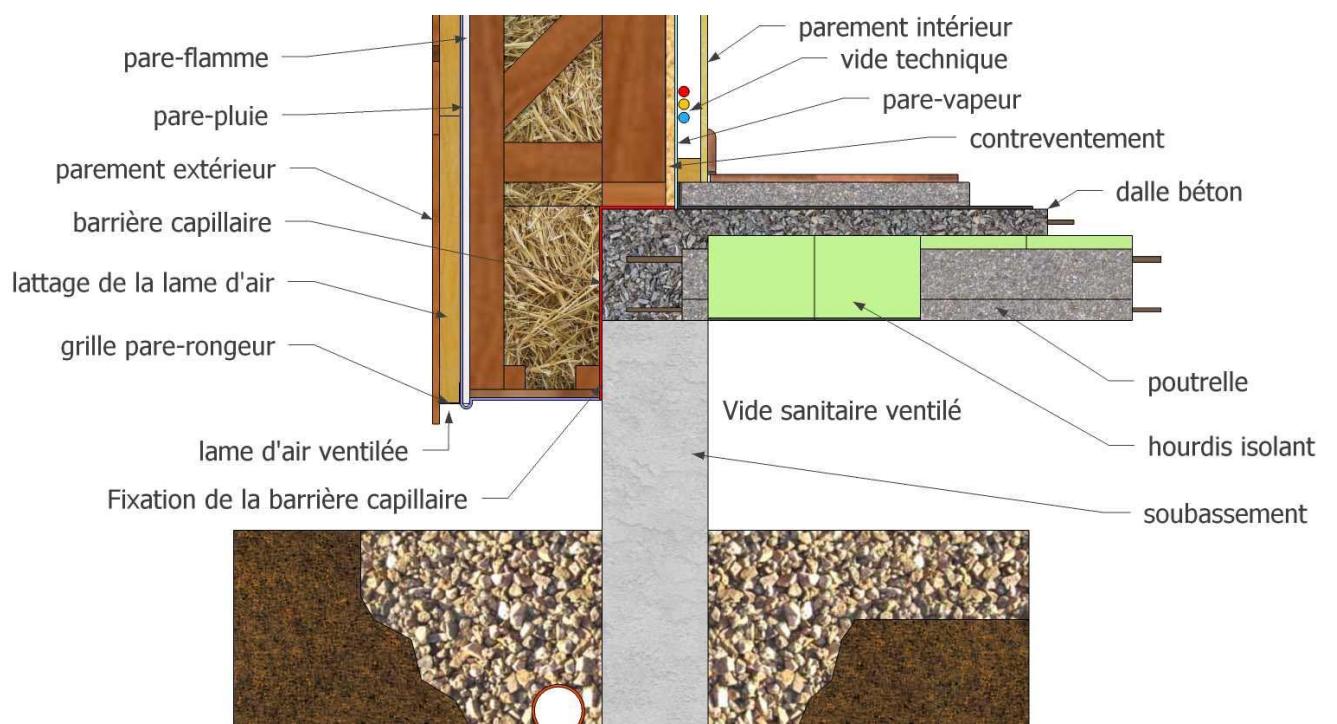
Présence d'une barrière capillaire à la jonction mur - plancher bas (construction neuve) (2)
